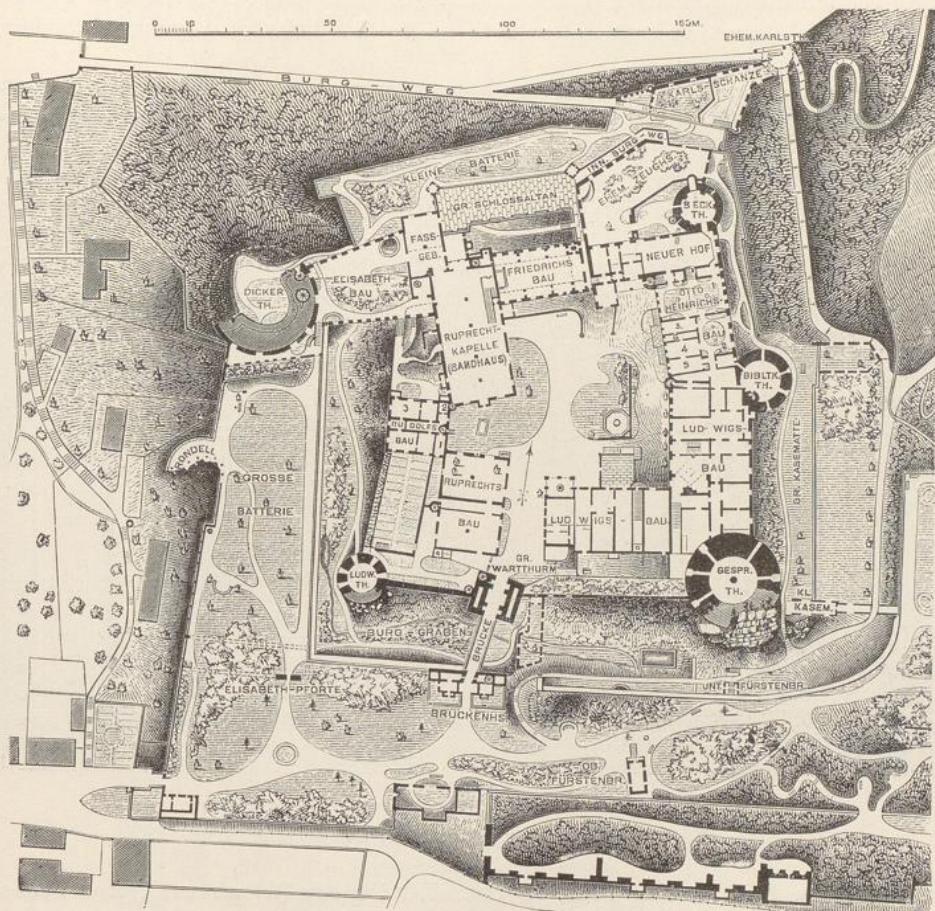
Das Schloß zu Heidelberg. Lageplan.
